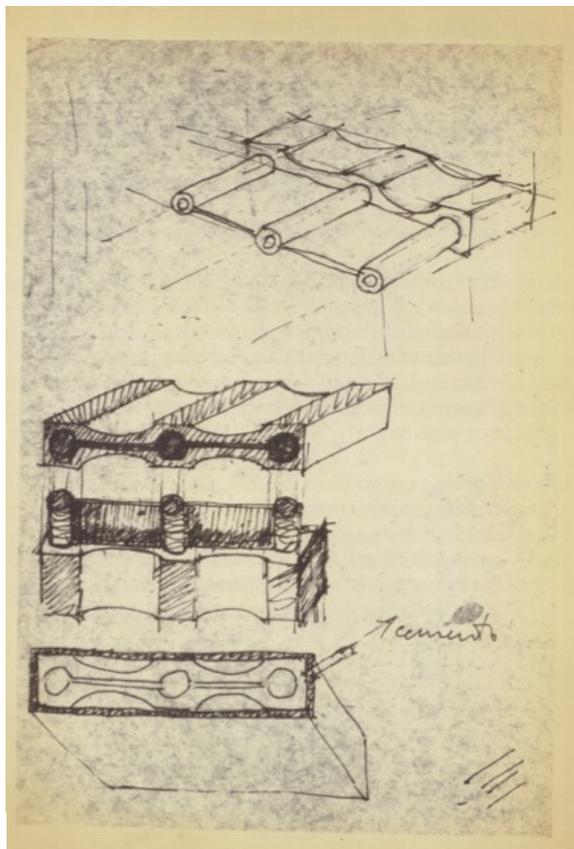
F. Lo Savio, *Complesso di strutture: sezione*, 1961.
